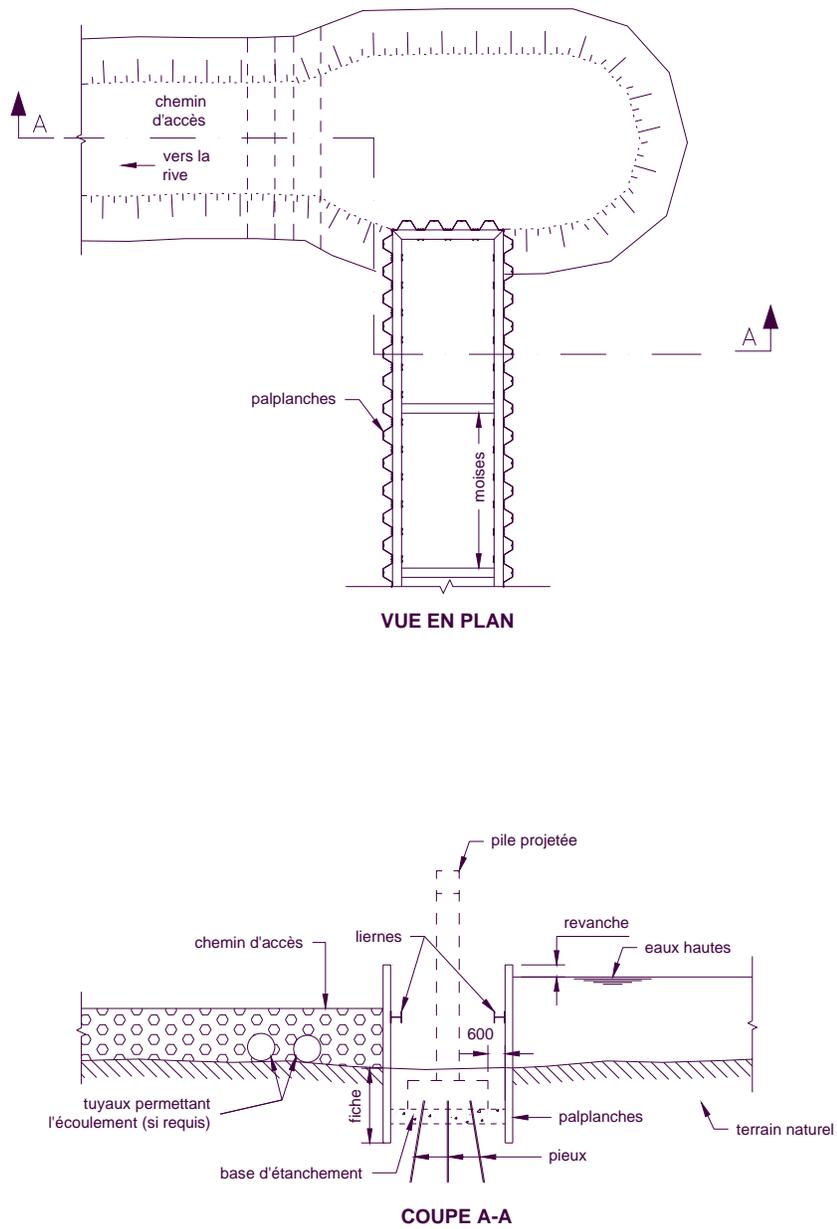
Batardeau en palplanches métalliques – Exemple
